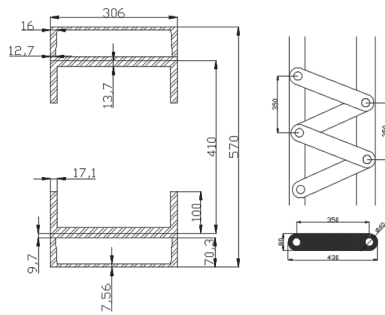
Sección transversal con dimensiones del elemento AAR-9-1.
